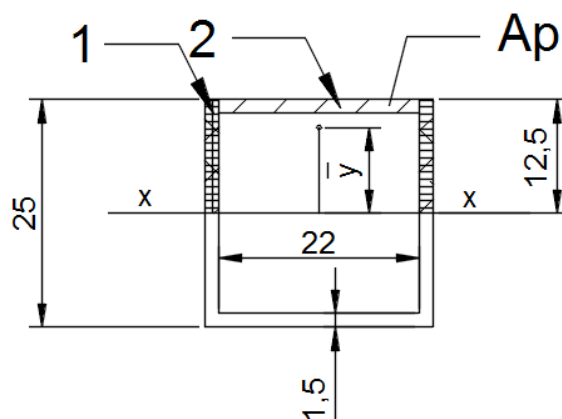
Representación de A_p y \bar{y} sección transversal, viga A-B
